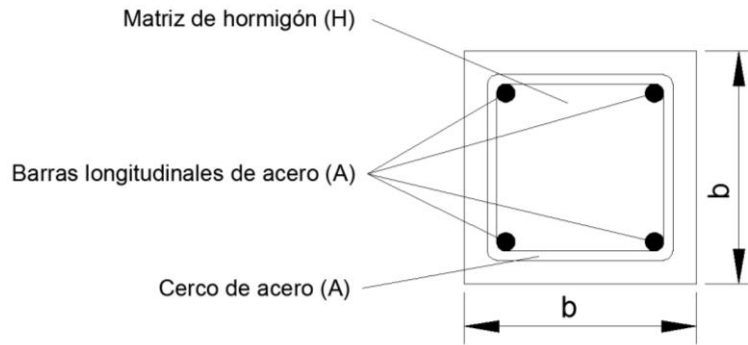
Esquema de la sección de la barra de hormigón armado con cercos
